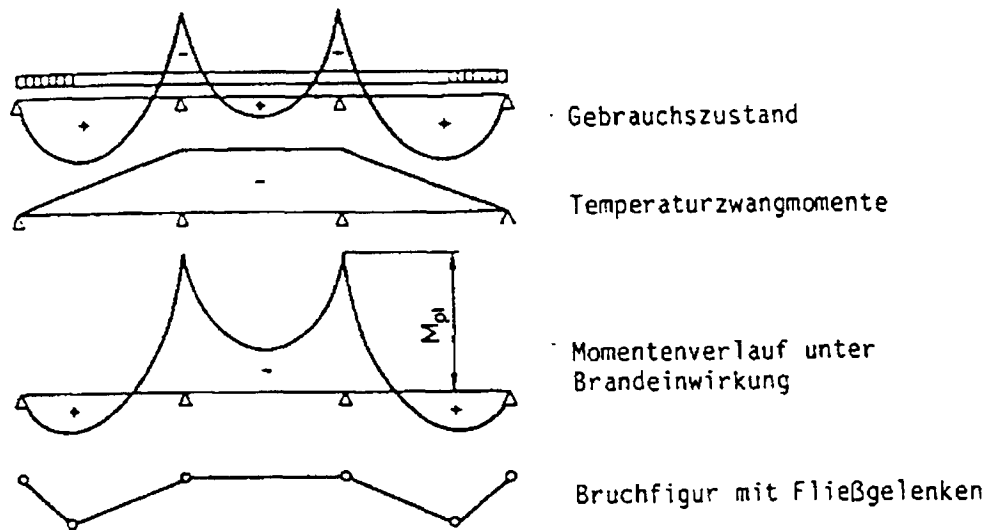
Momentenumlagerung und Bruchvorgang bei Durchlaufsystemen im Brandfall
